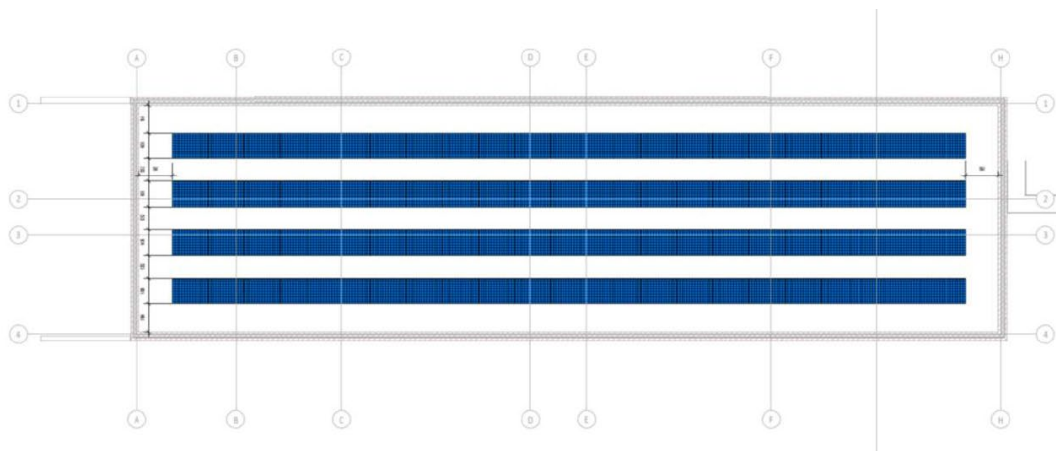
Dachaufsicht Betriebsgebäude – Aufstellung der PV-Anlage auf dem Dach
